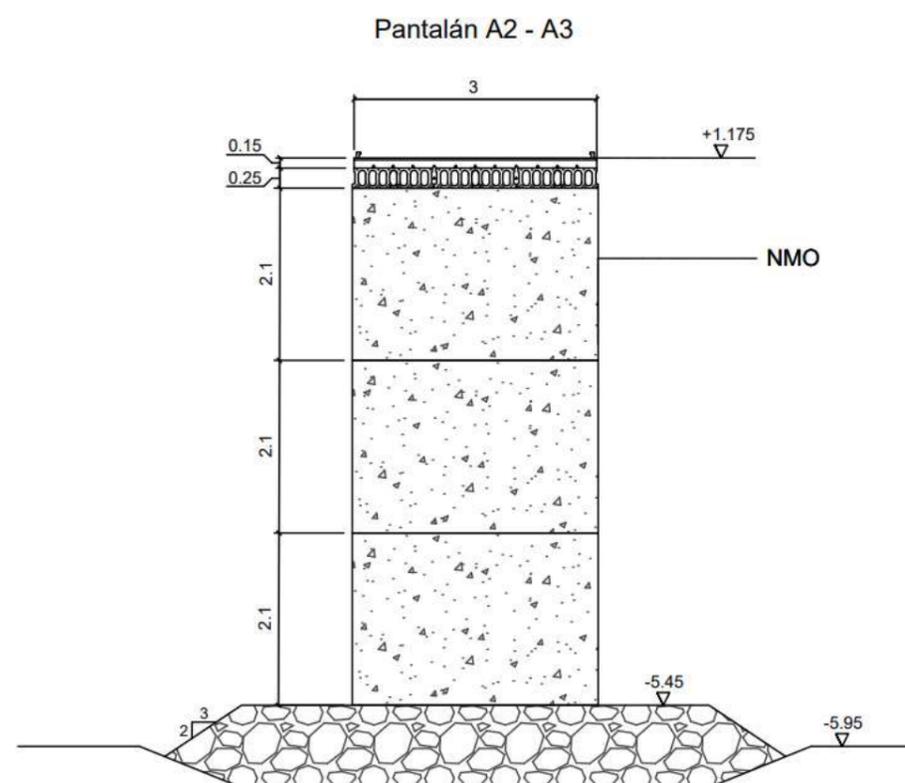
Sección transversal pilas del pantalán A2-A3. Fuente: Elaboración propia.
